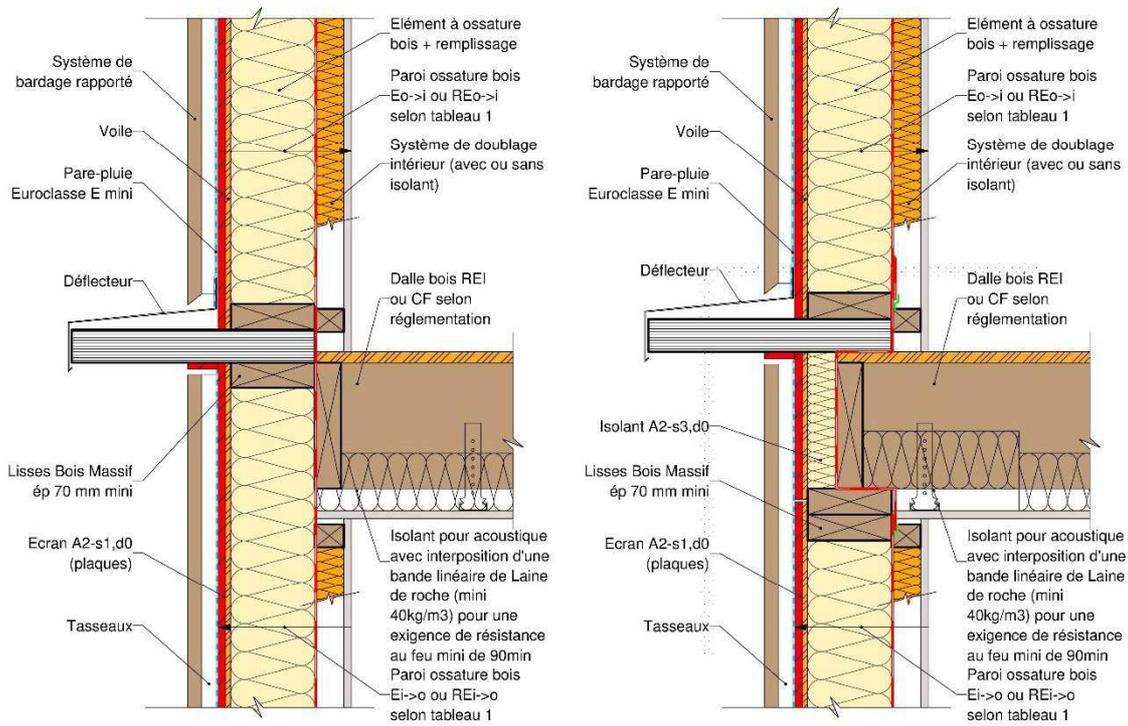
Exemple de paroi avec déflecteurs renforcés d'une Façade/mur ossature bois & plancher en ossature bois.
